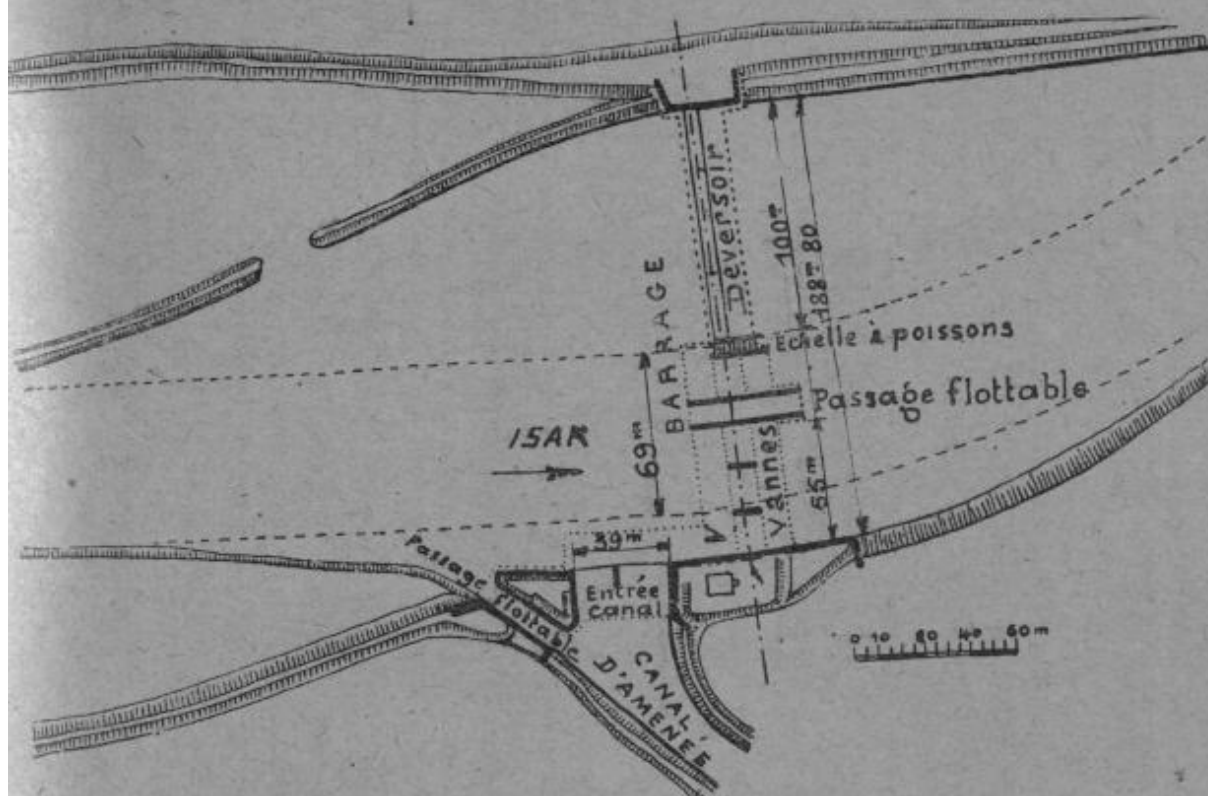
Usine de Uppernborn. Plan des ouvrages hydrauliques à la prise d'eau.
